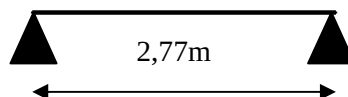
Schémas statiques des différents types des poutrelles
